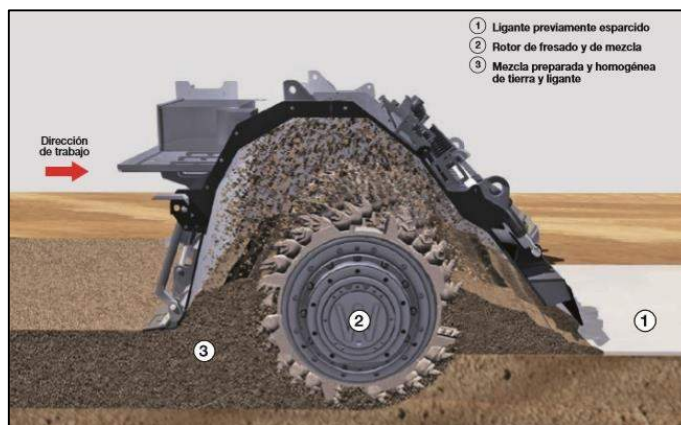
Tambor de reciclado / Rotor de fresado
